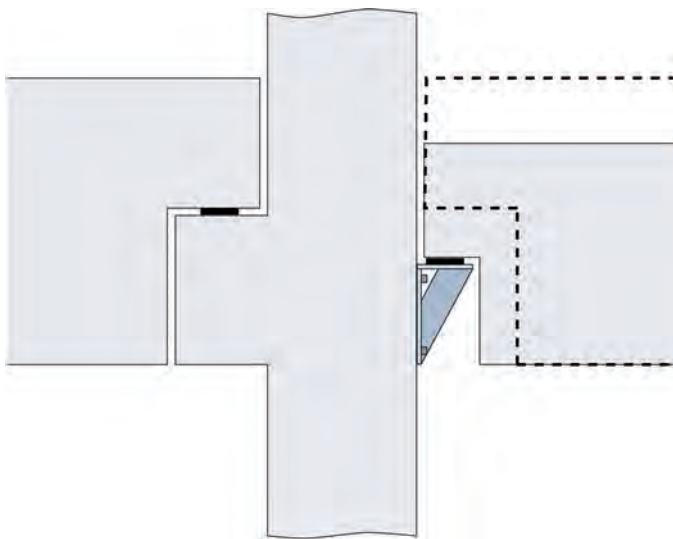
Stahlbetonkonsolen (links) und angeschraubte Stahlkonsolen (rechts)
